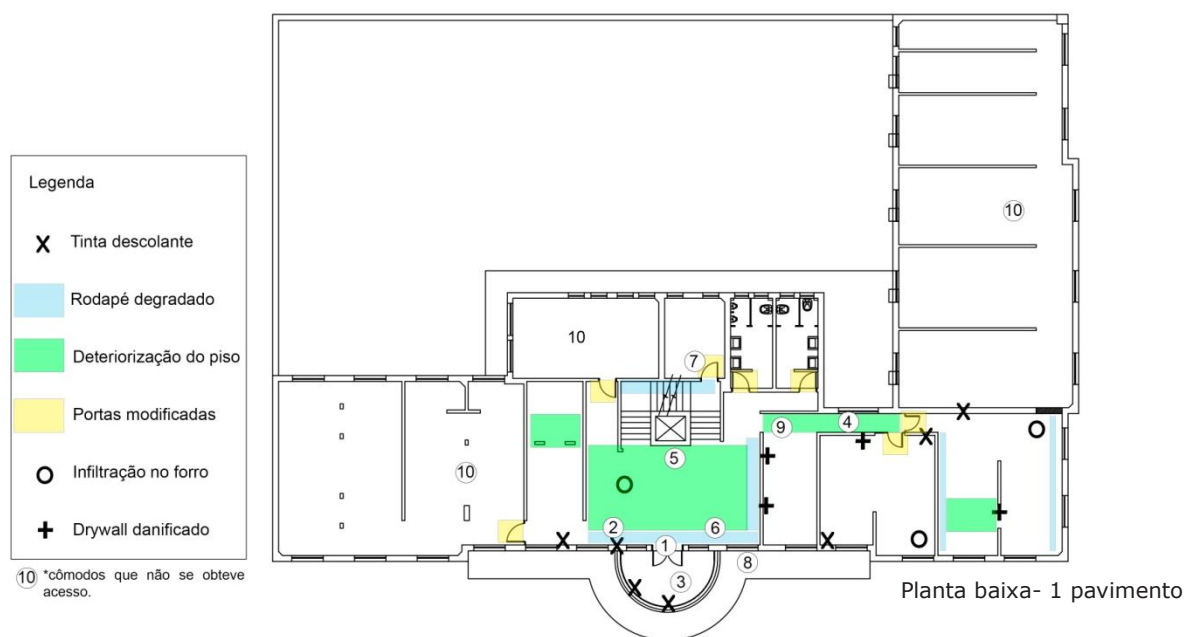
Situação atual do Pavimento Térreo, Salão e Banheiro
